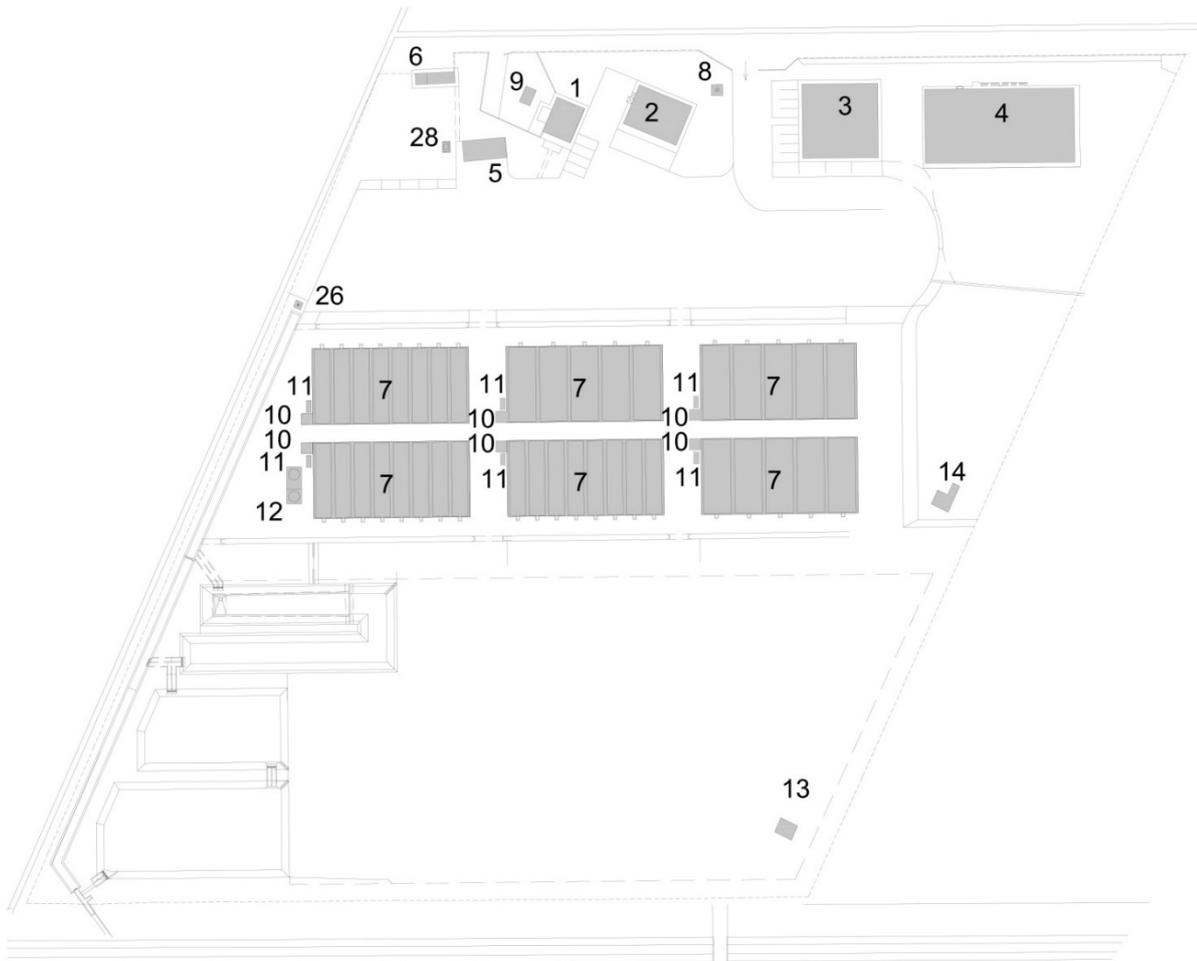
Area 1- Pianta chiave dello stato attuale
